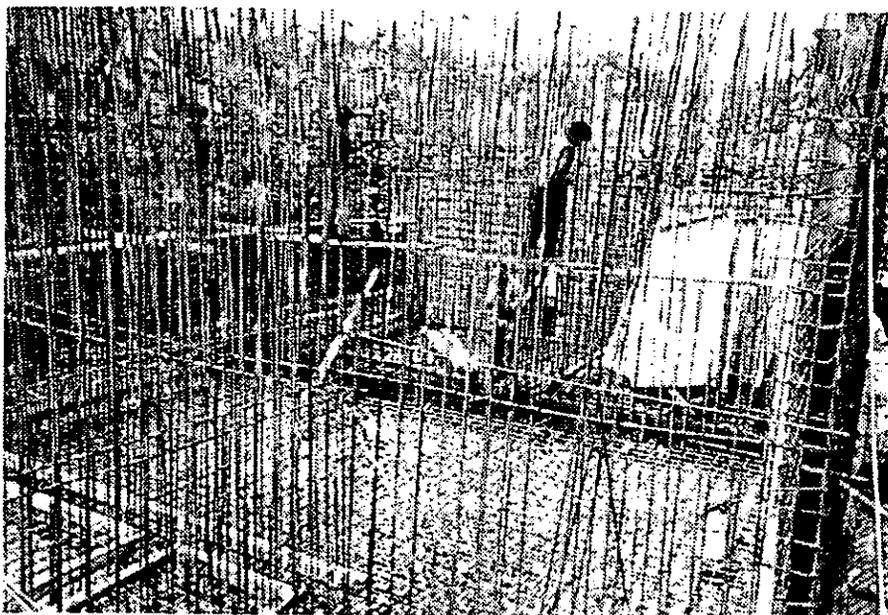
Armado de la estructura y de la losa de cimentación que se colarán monolíticamente.
